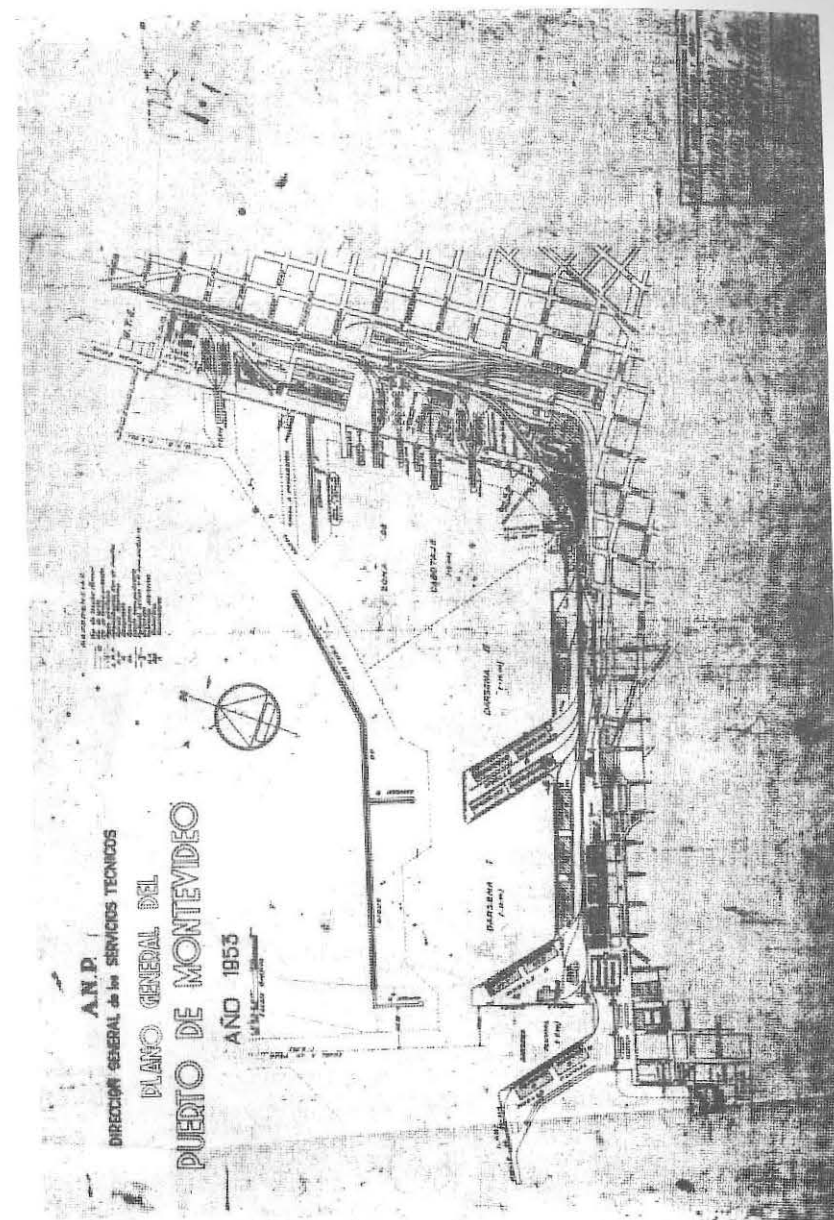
Puerto de Montevideo, Planimetría, 1953.
